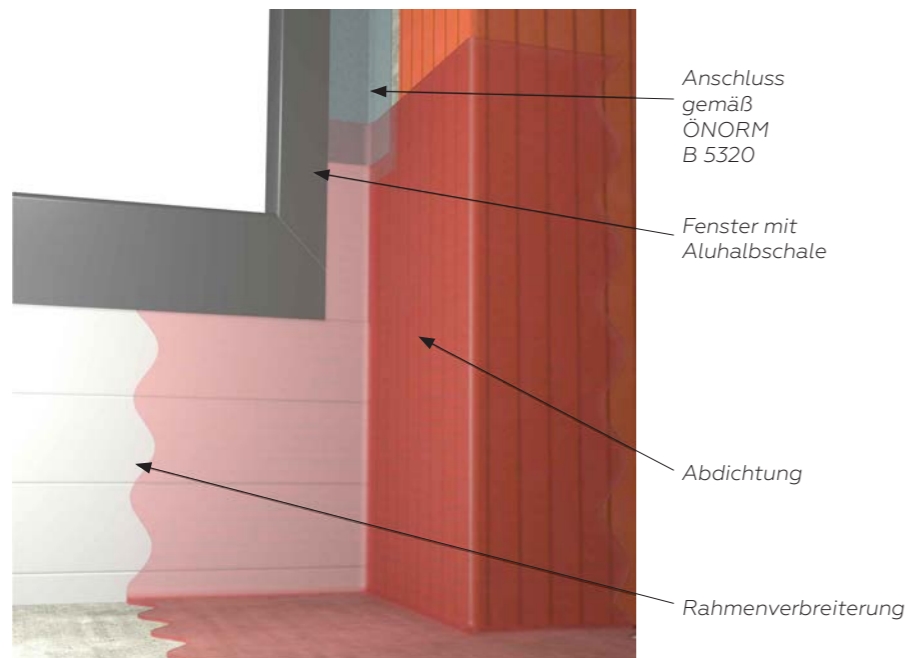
Prinzipskizze Fenster flächenbündiger Ausführung und Abdichtung
